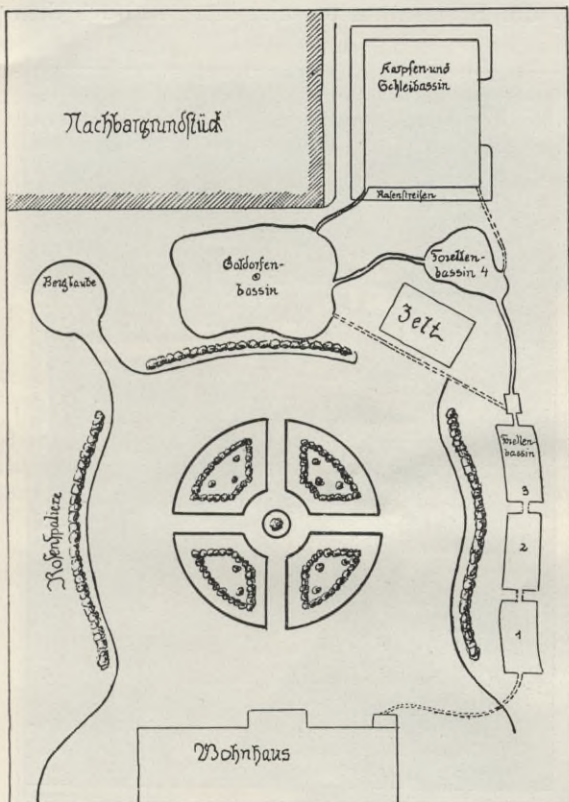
Grundriß einer Teichanlage aus Beton in einem Villengarten.
